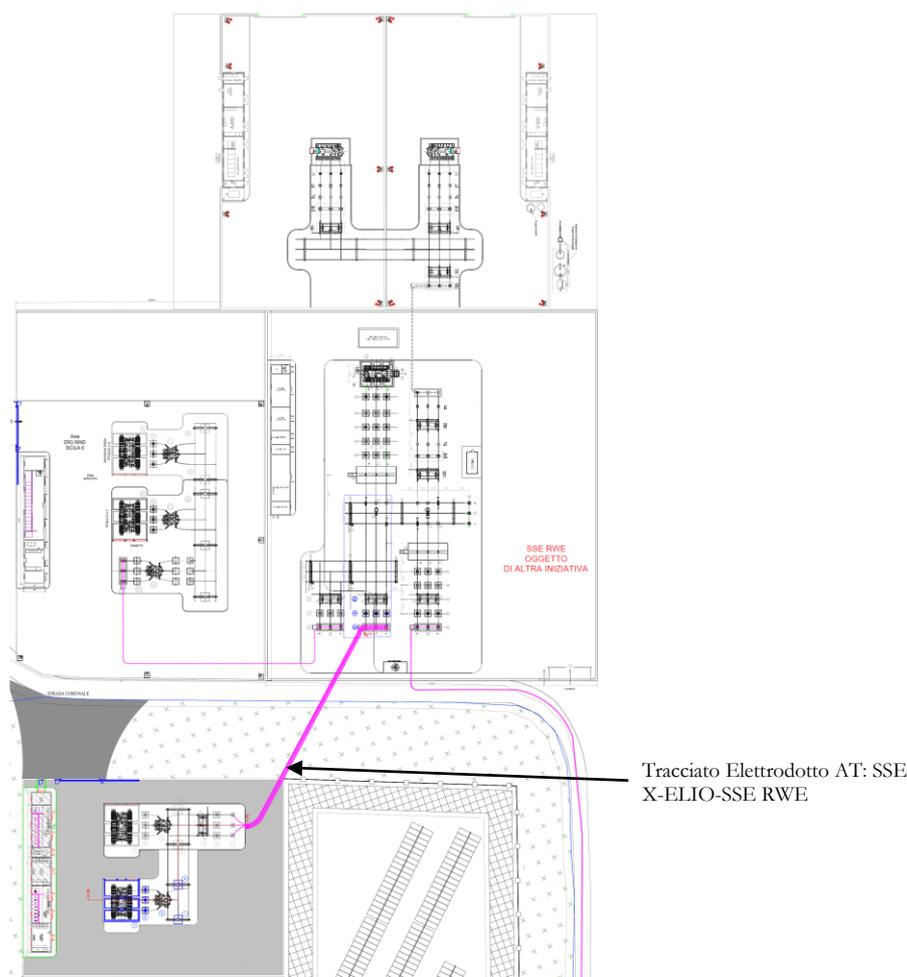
Tracciato elettrodotto AT di collegamento fra le SSE XELIO e SSE RWE
